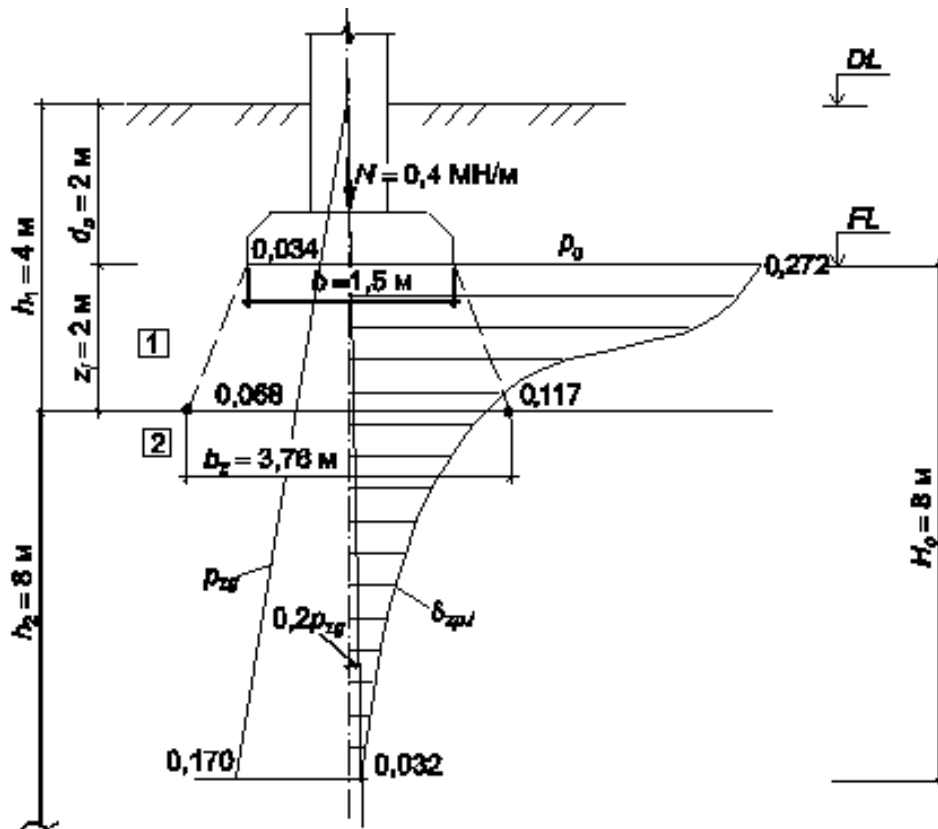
Расчетная схема основания фундамента к примеру 4
